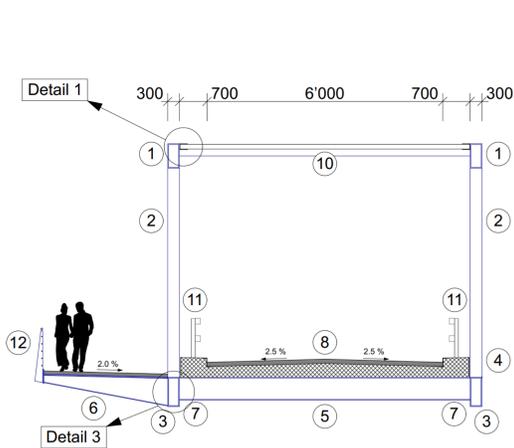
Schnitt 1-1 — Fachwerkträgerbrücke
